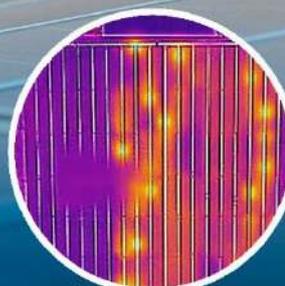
1: Falta de aislamiento en la fachada (FLIR Systems)	7
